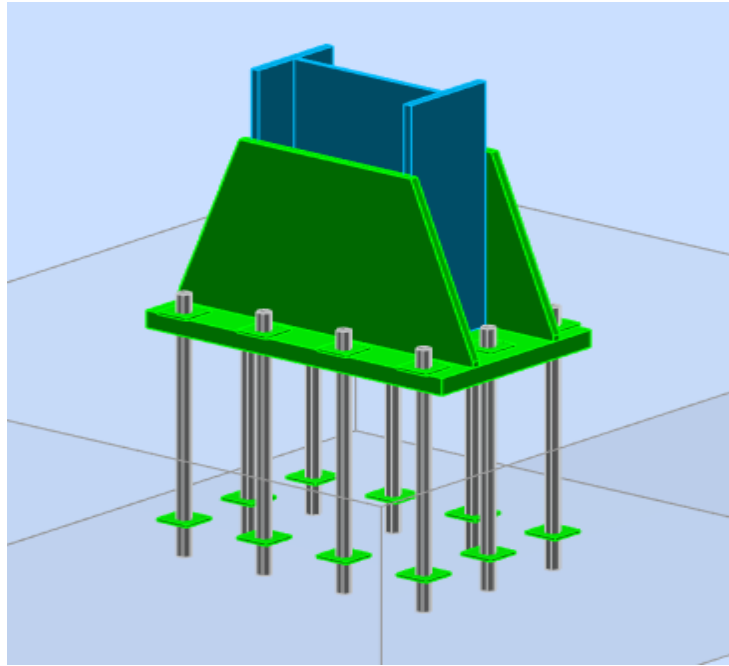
Vue d'assemblage pied de poteau HEA550
